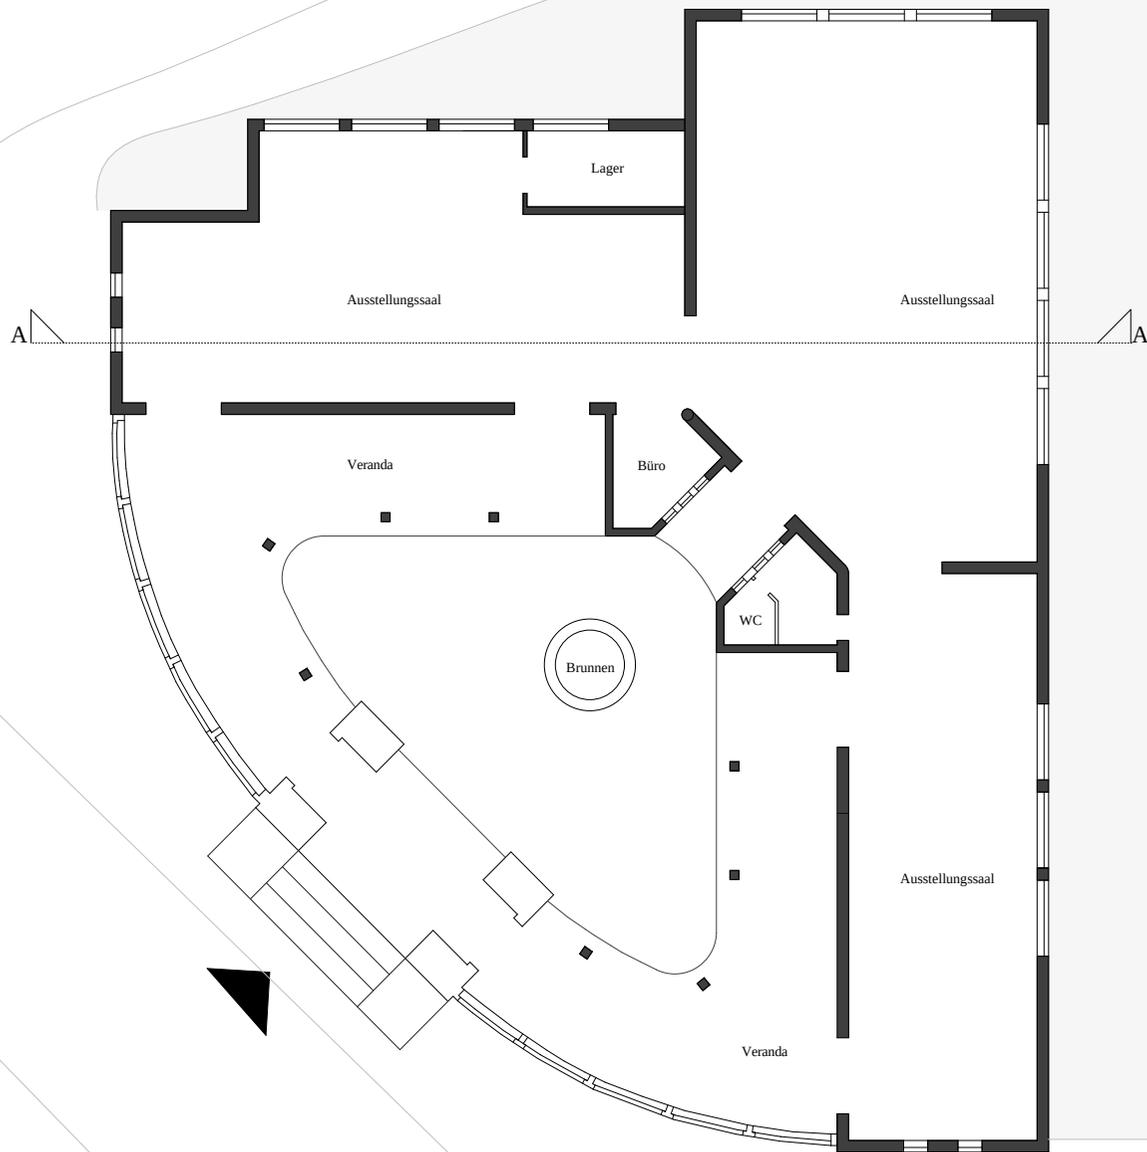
| Grundriss des italienischen Pavillons
